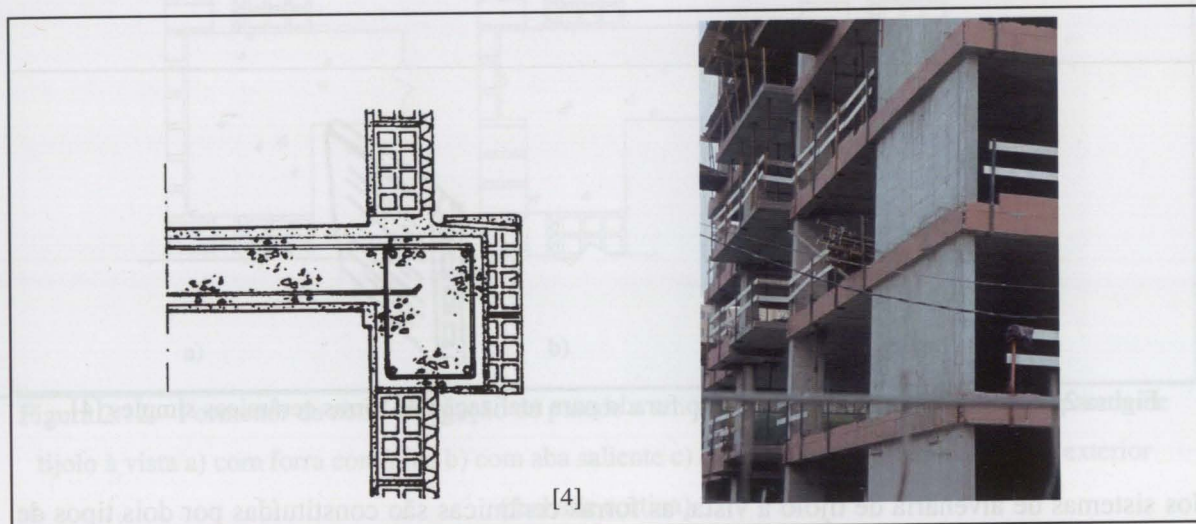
Exemplos de forra cerâmica simples ou duplas pelo exterior realizadas antes do pano exterior integradas no sistema de cofragem das lajes e vigas
